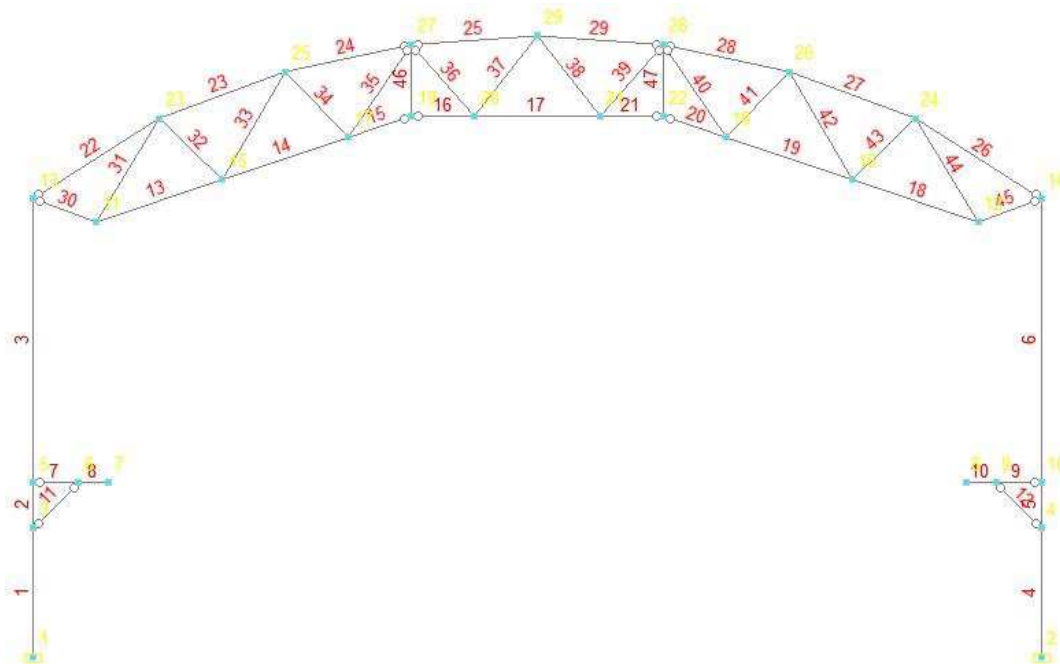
Расчетная схема поперечника блока №1 в осях Б-М
